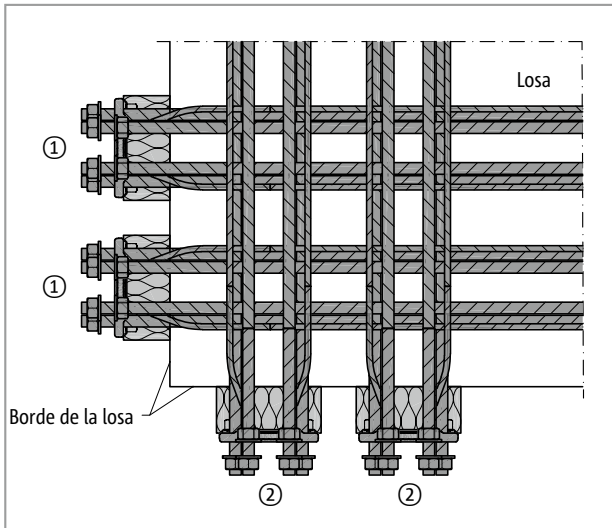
Schöck Isokorb® T tipo SK: Esquinero externo
